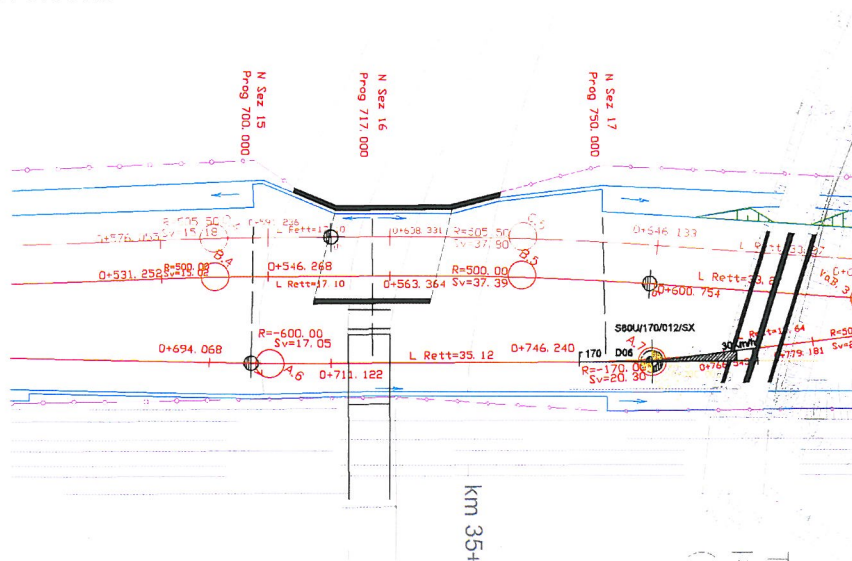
Schema planimetrico del manufatto e dei binari sottopassanti
